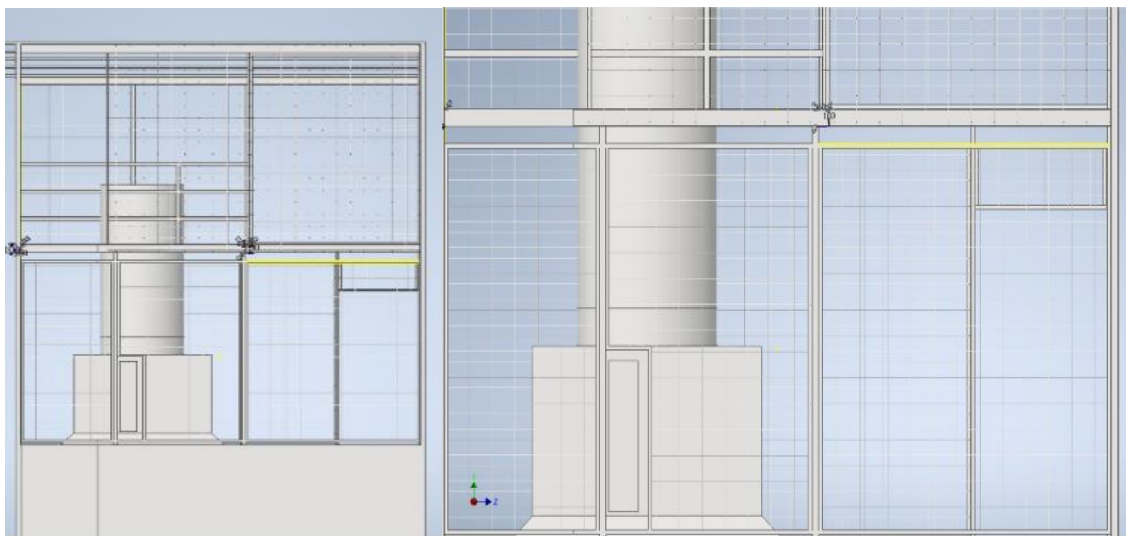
Diseño montaje de malla electro soldada
